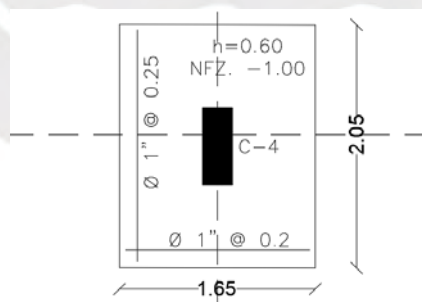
Diseño zapata aislada C4 (Pórtico B)
